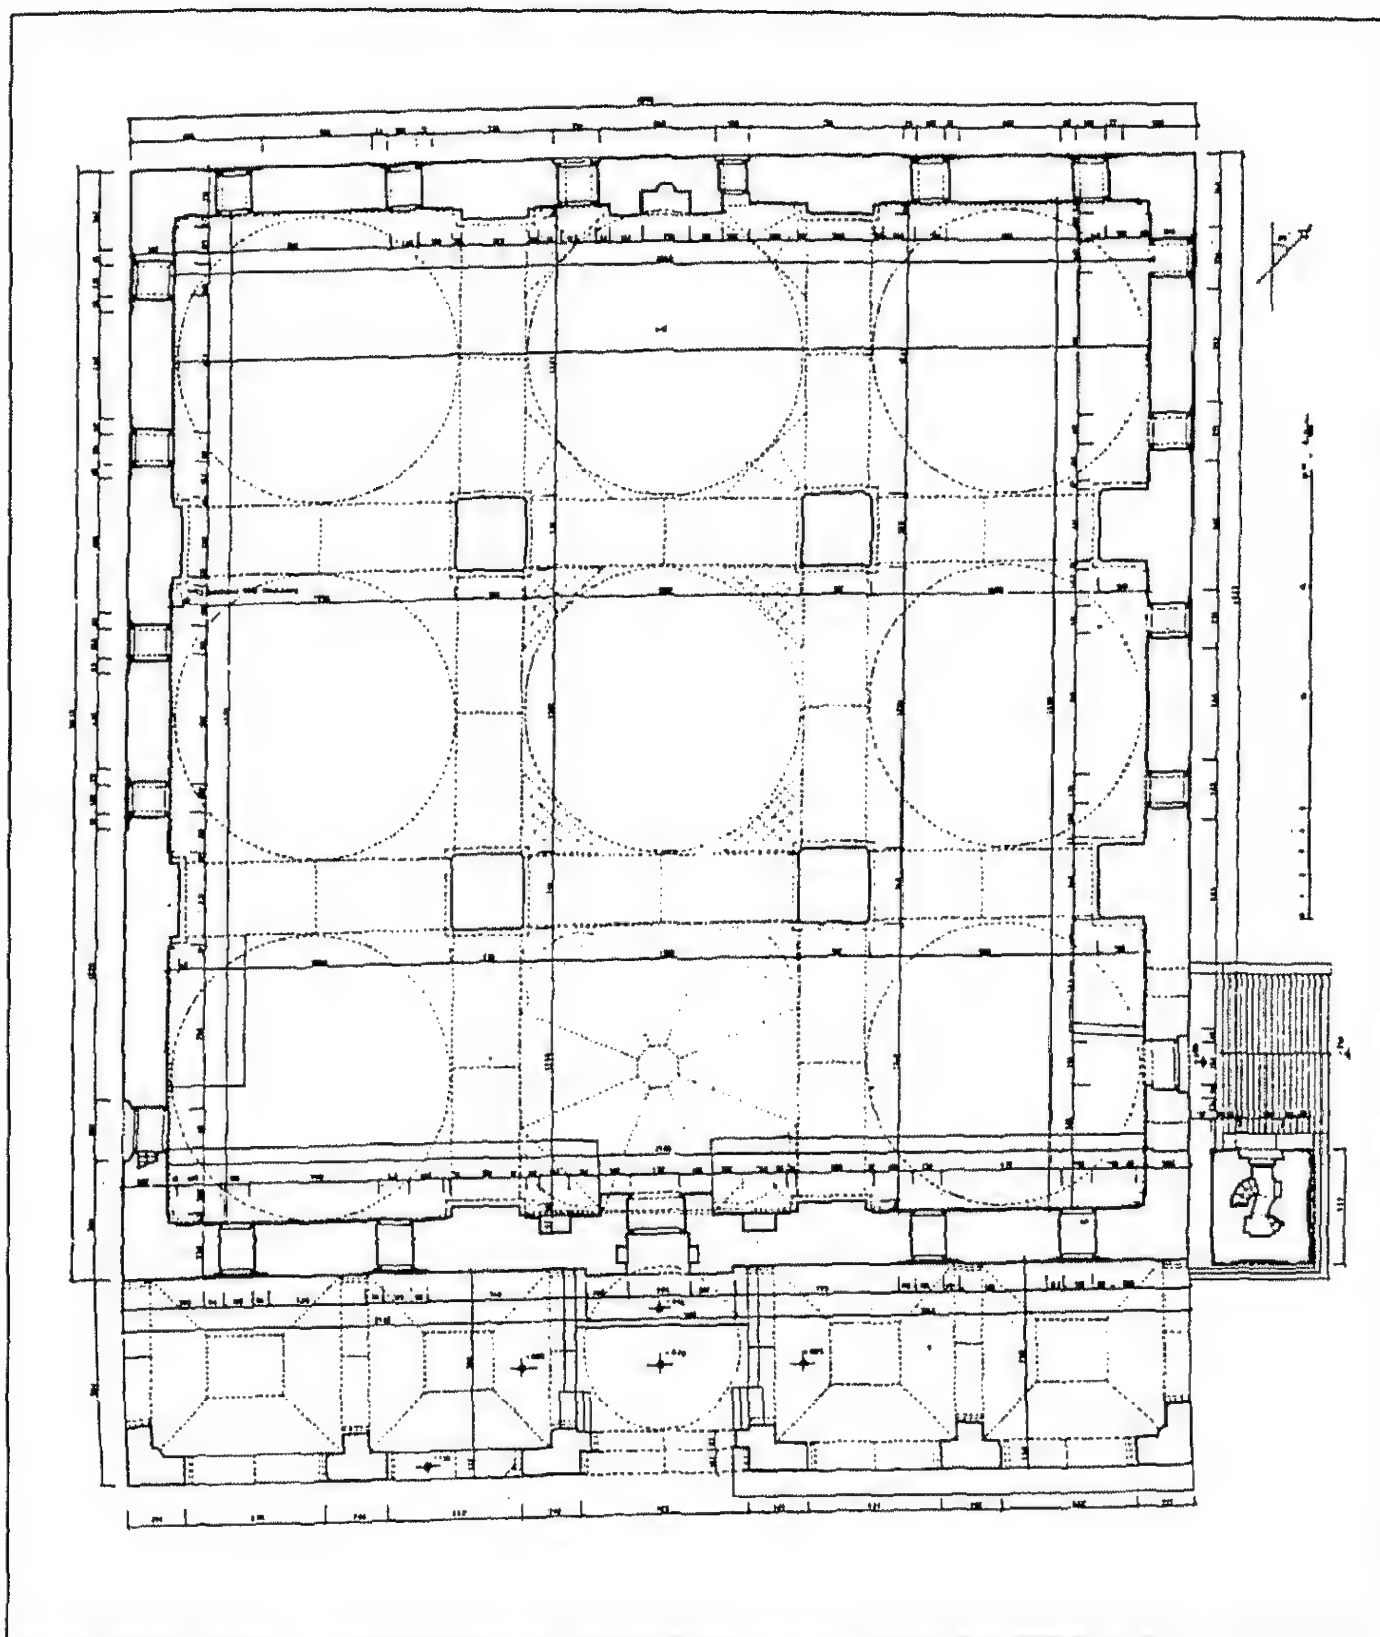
مسقط أفقي لمسجد روم محمد باشا في اسكدار باستانبول (عن : جودوين) .
